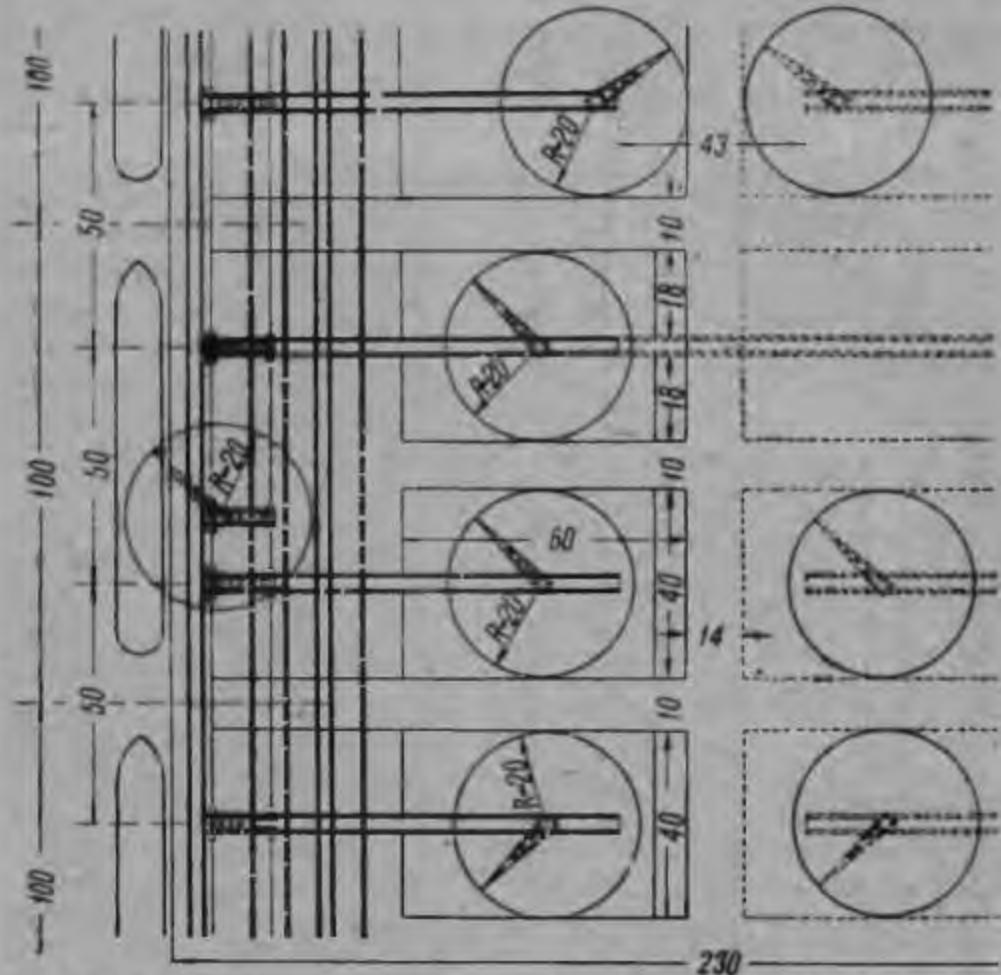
Схема оборудования для погрузки круглого леса посредством поворотных кранов на эстакаде.
